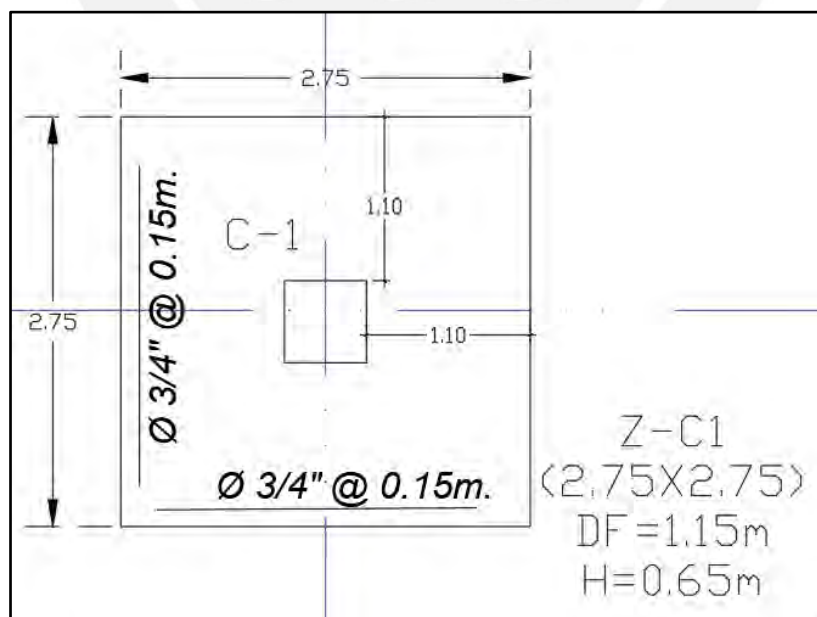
Sección Z-01 para la columna C-1 (Fuente propia)
